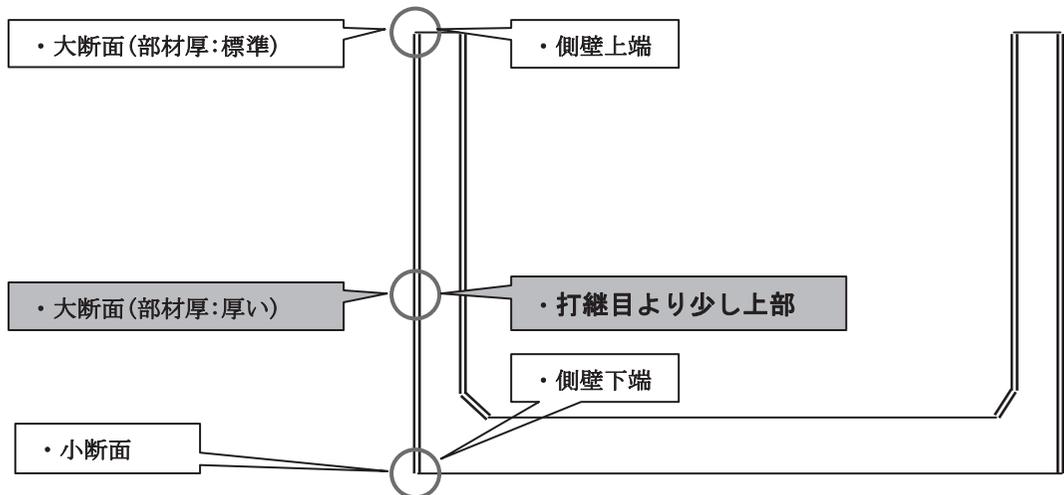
最小ひび割れ指数発生箇所の模式図
